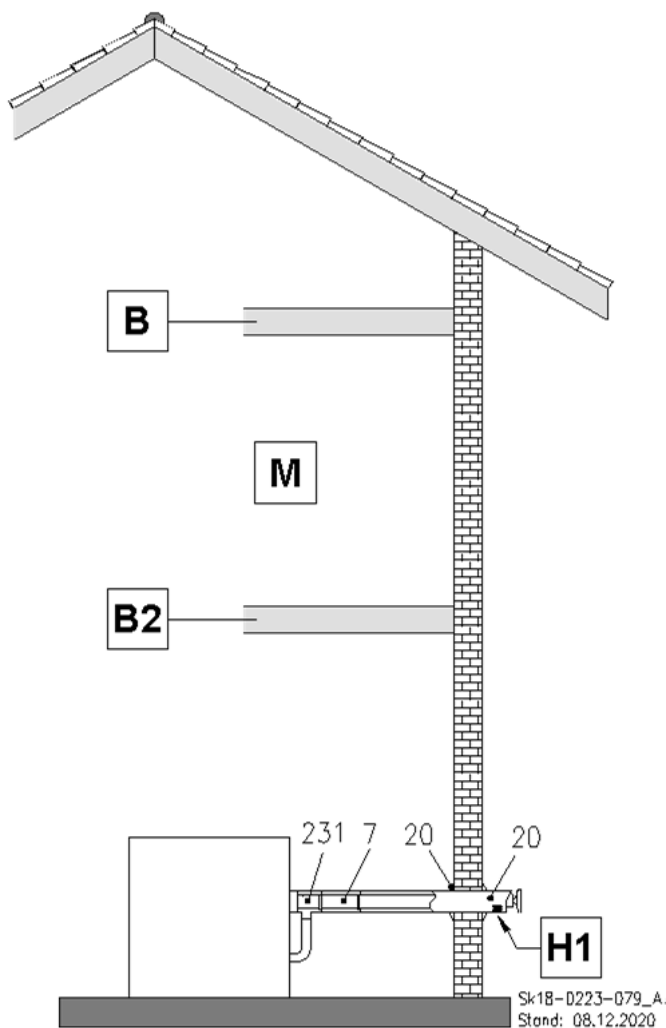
C_{13x} Système de tuyau concentrique LAS horizontal traversant le mur extérieur
